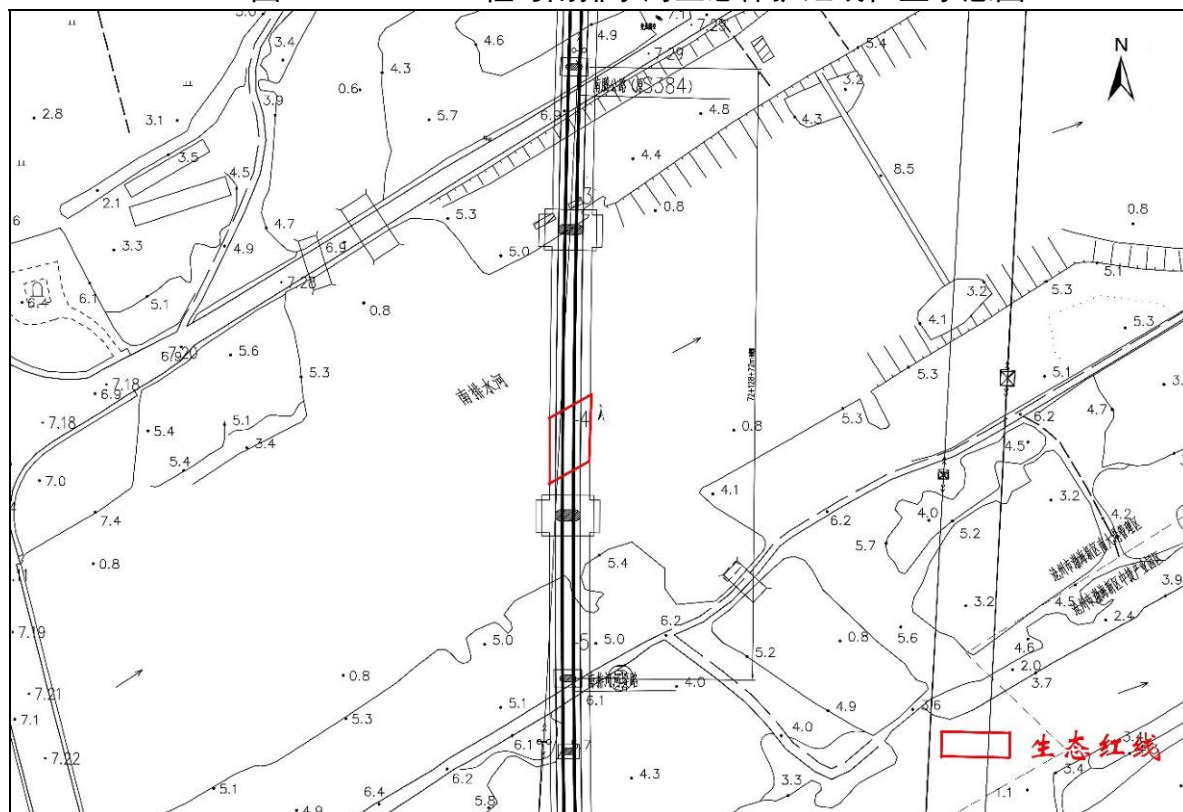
XI-5 工程跨越南排水河桥梁及墩台平面布置示意图
